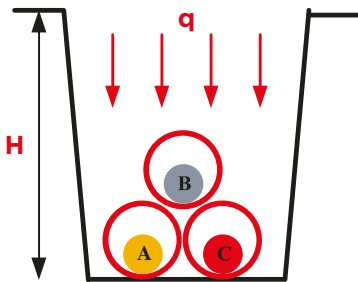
Воздействие на трубу вертикальной нагрузки  $q$  (в качестве примера показан пучок из трех труб с кабелями фаз А, В, С)
